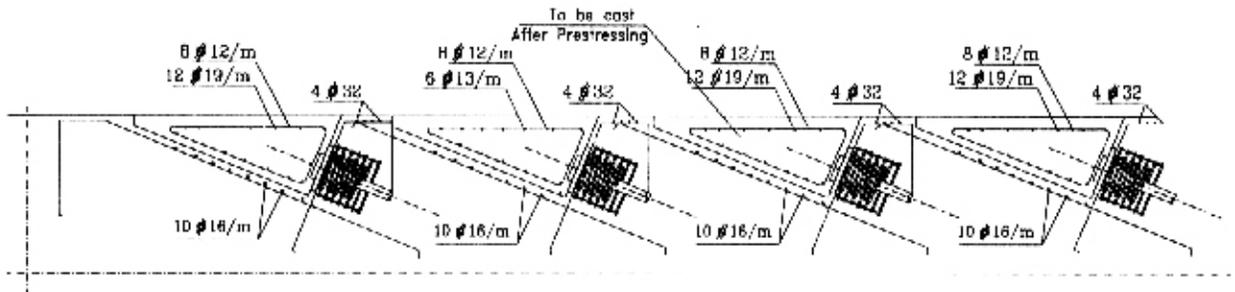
تفصيلة ل Anchor توصيل متعدد المستويات
